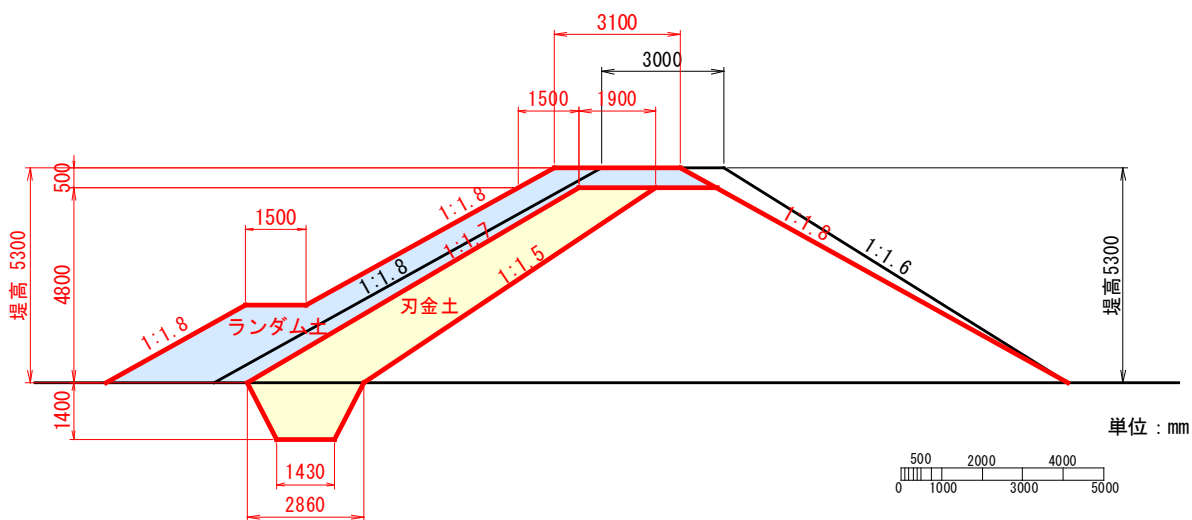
施工コスト算定用計画堤体断面（前刃金工法）-1（H=5.3 m）
